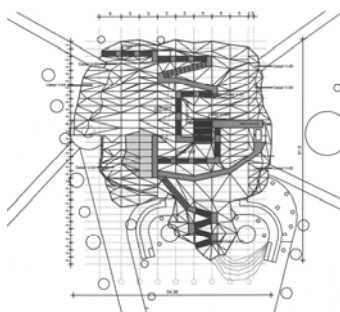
Planta de cobertura, pavilhão da MVRDV, 2004.
